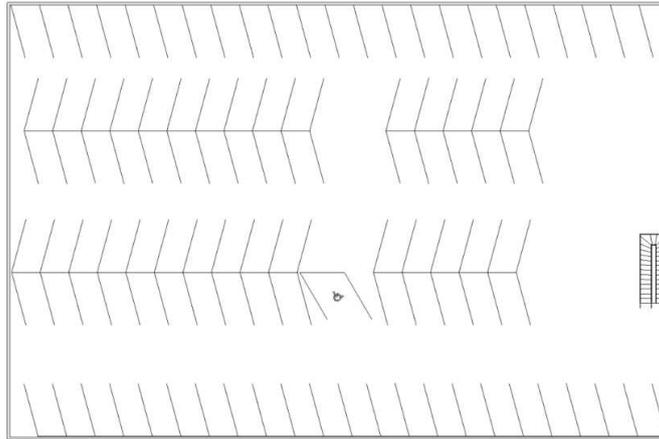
Grundriss OG 3 BIM-Modell WGarG §8 Abs 1
